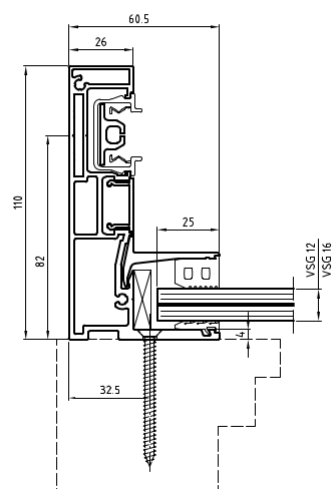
Führungsschienentypen Fa. WAREMA Renkhoff SE
